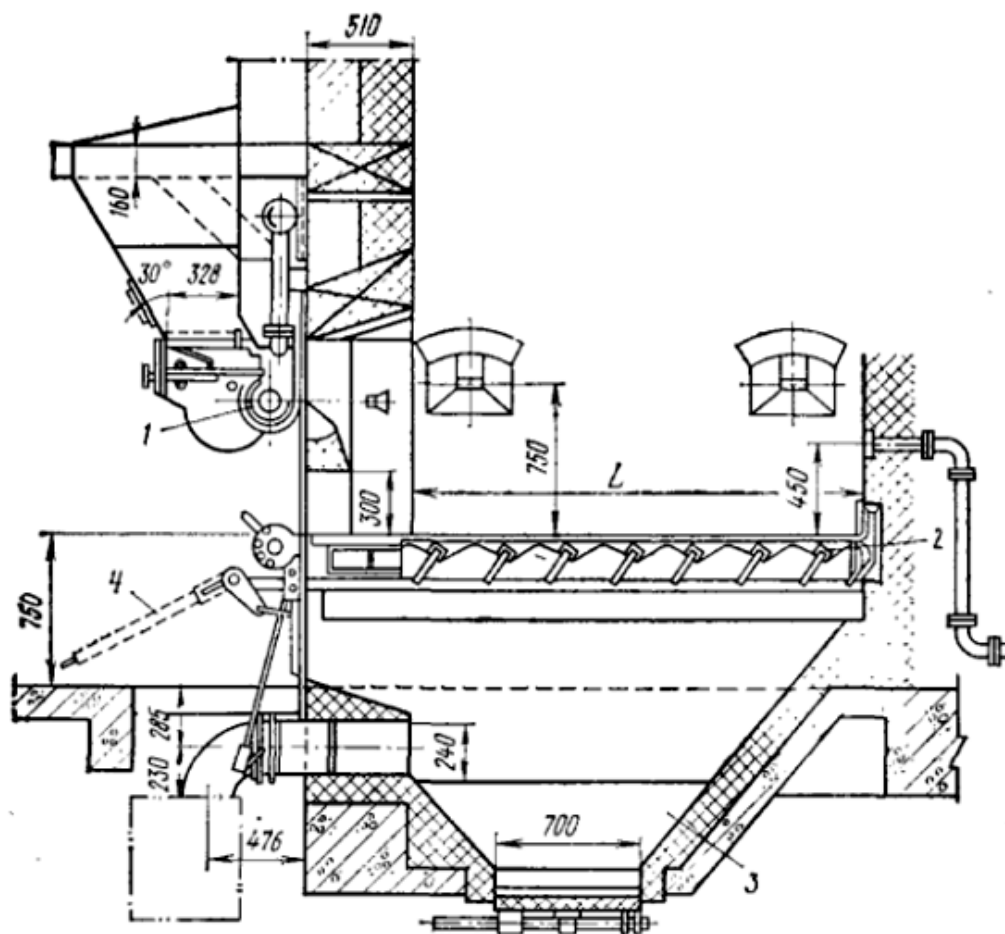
Схема полумеханической топки с пневмомеханическим забрасывателем и решеткой с поворотными колосниками
